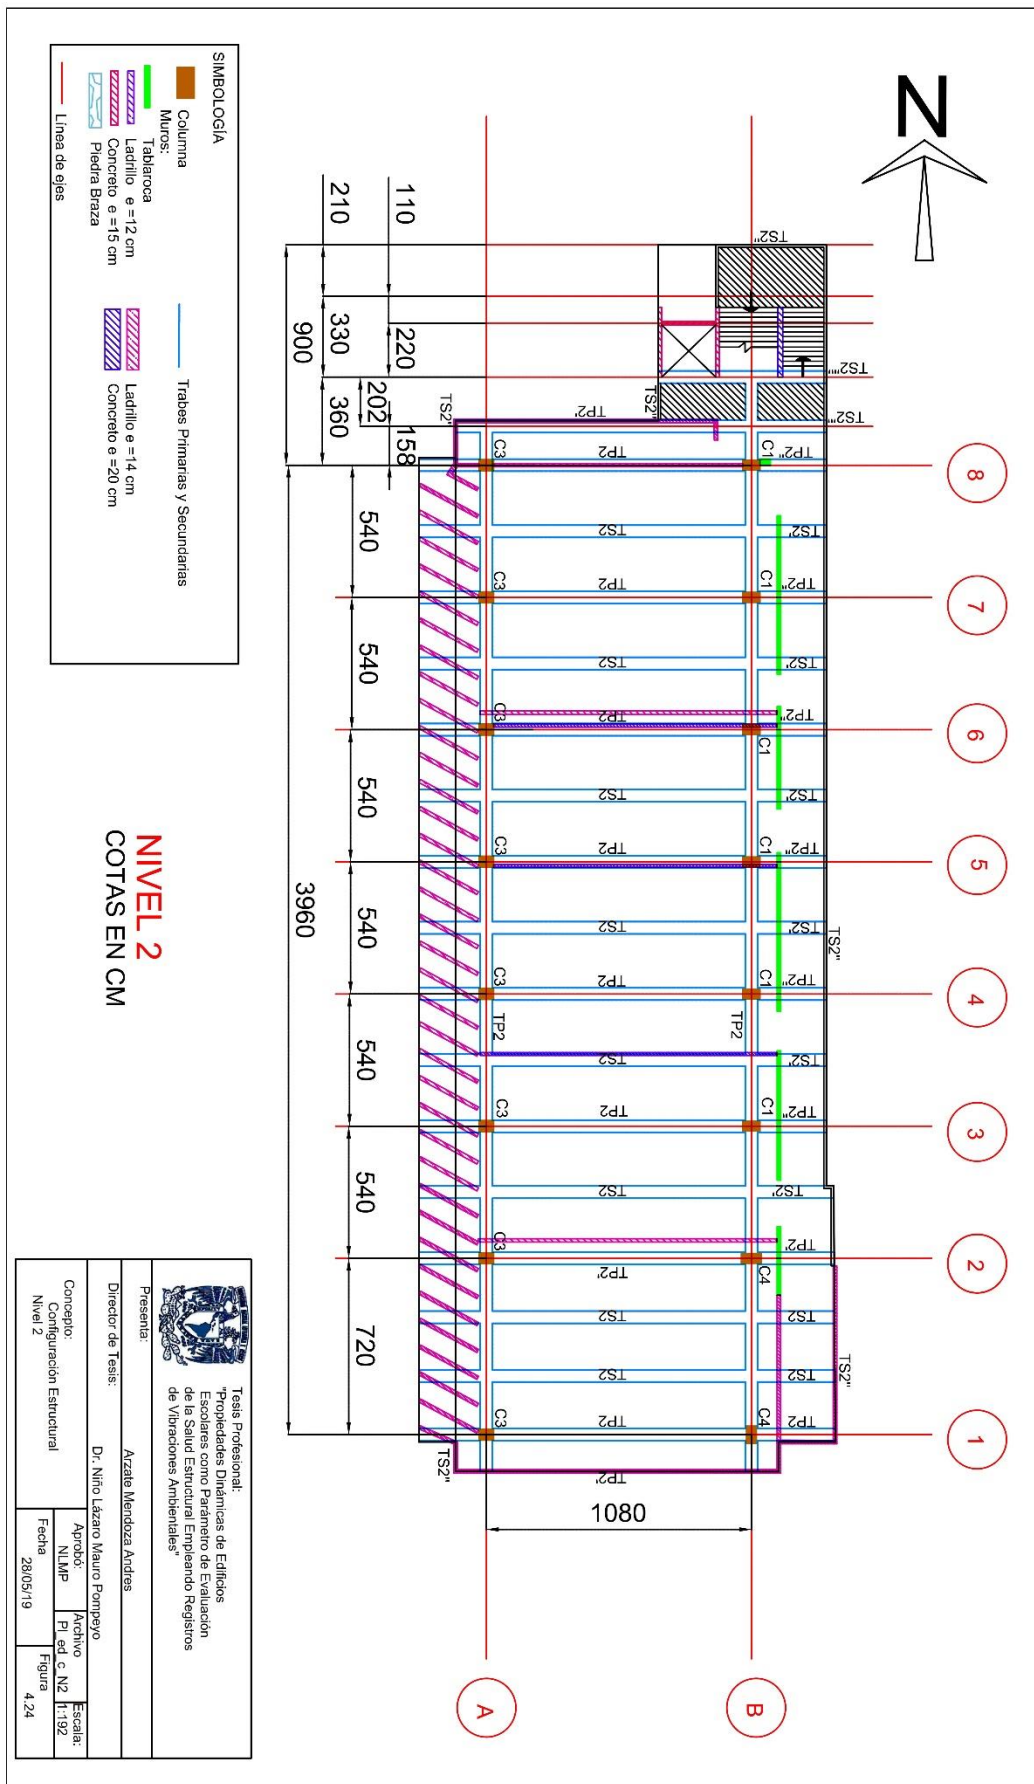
Planta estructural nivel 2 edificio C FI, UNAM
